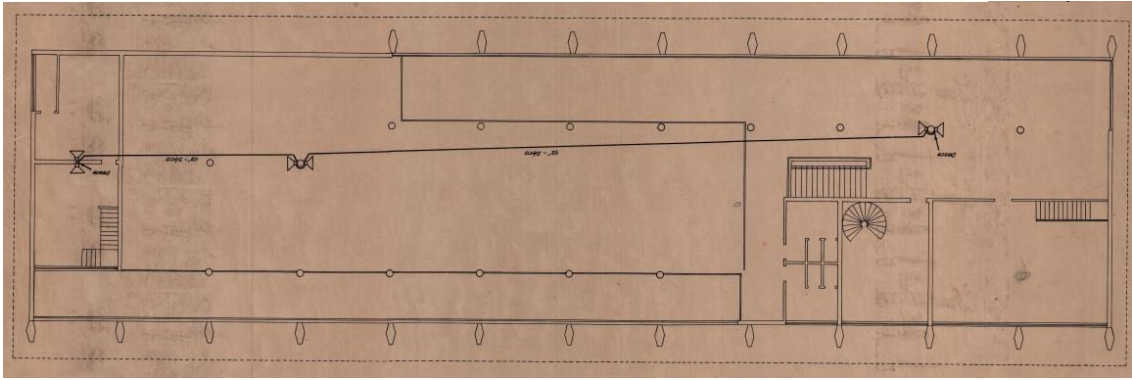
1952. / Planta do pavimento superior do Terminal Rodoviário Luís Garcia. ©DER.
